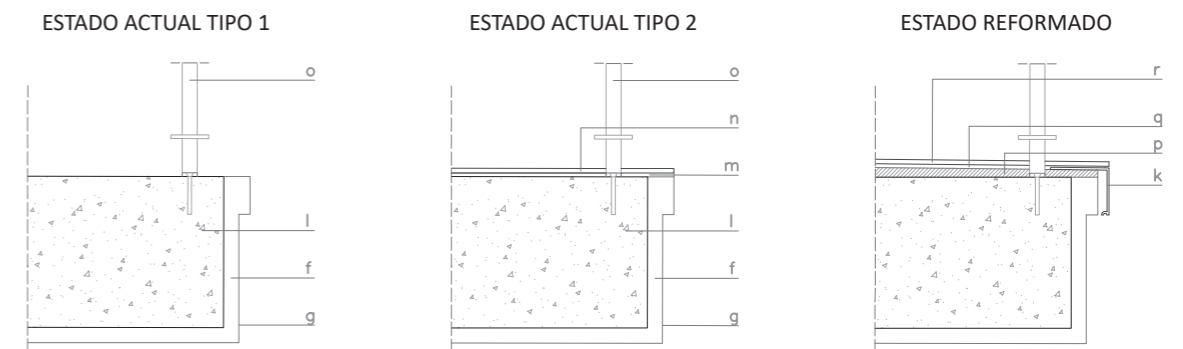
Detalle constructivo. Remate balcones y miradores. Fachada principal. [Tabla 1]
